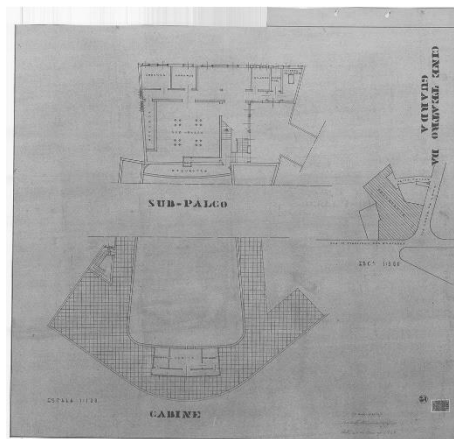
Cineteatro da Guarda, Planta subpalco e cabine
